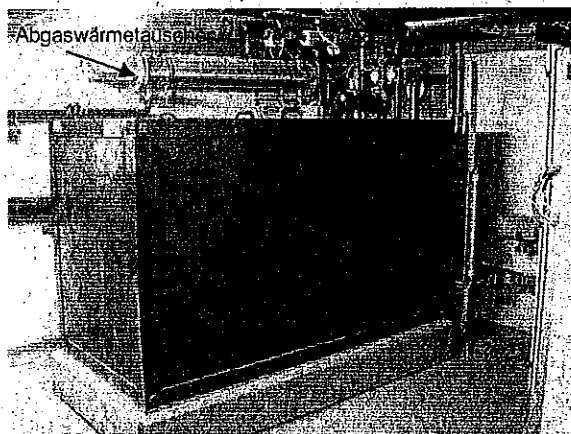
Blockheizkraftwerk mit Abgaswärmetauscher Altenpflegeheim Stuttgart
